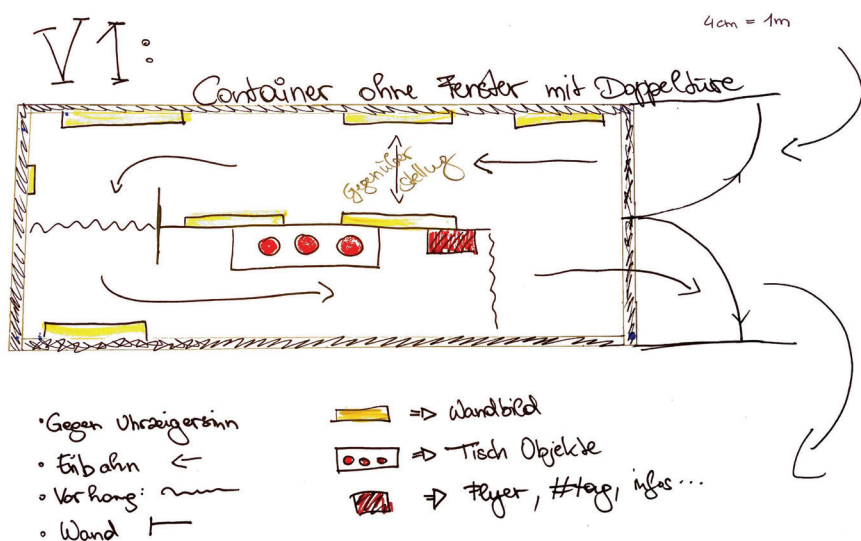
Grundriss-Skizze, Container ohne Fenster mit Doppeltüre
